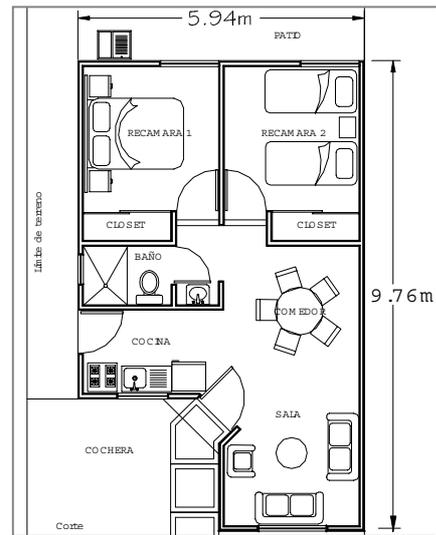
Planta Arquitectónica, Vivienda de interés social.
